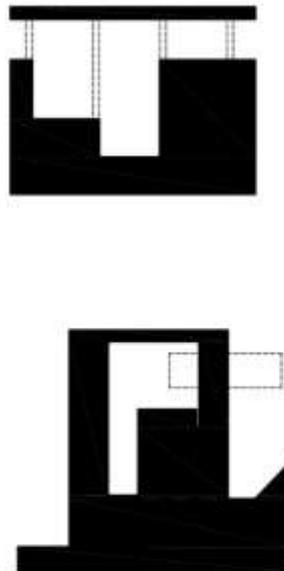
Diagramme de l'auteur fonds de coupes : Coupe Villa Shodhan FLC 6422 et Coupe Bianchi Est-Ouest
